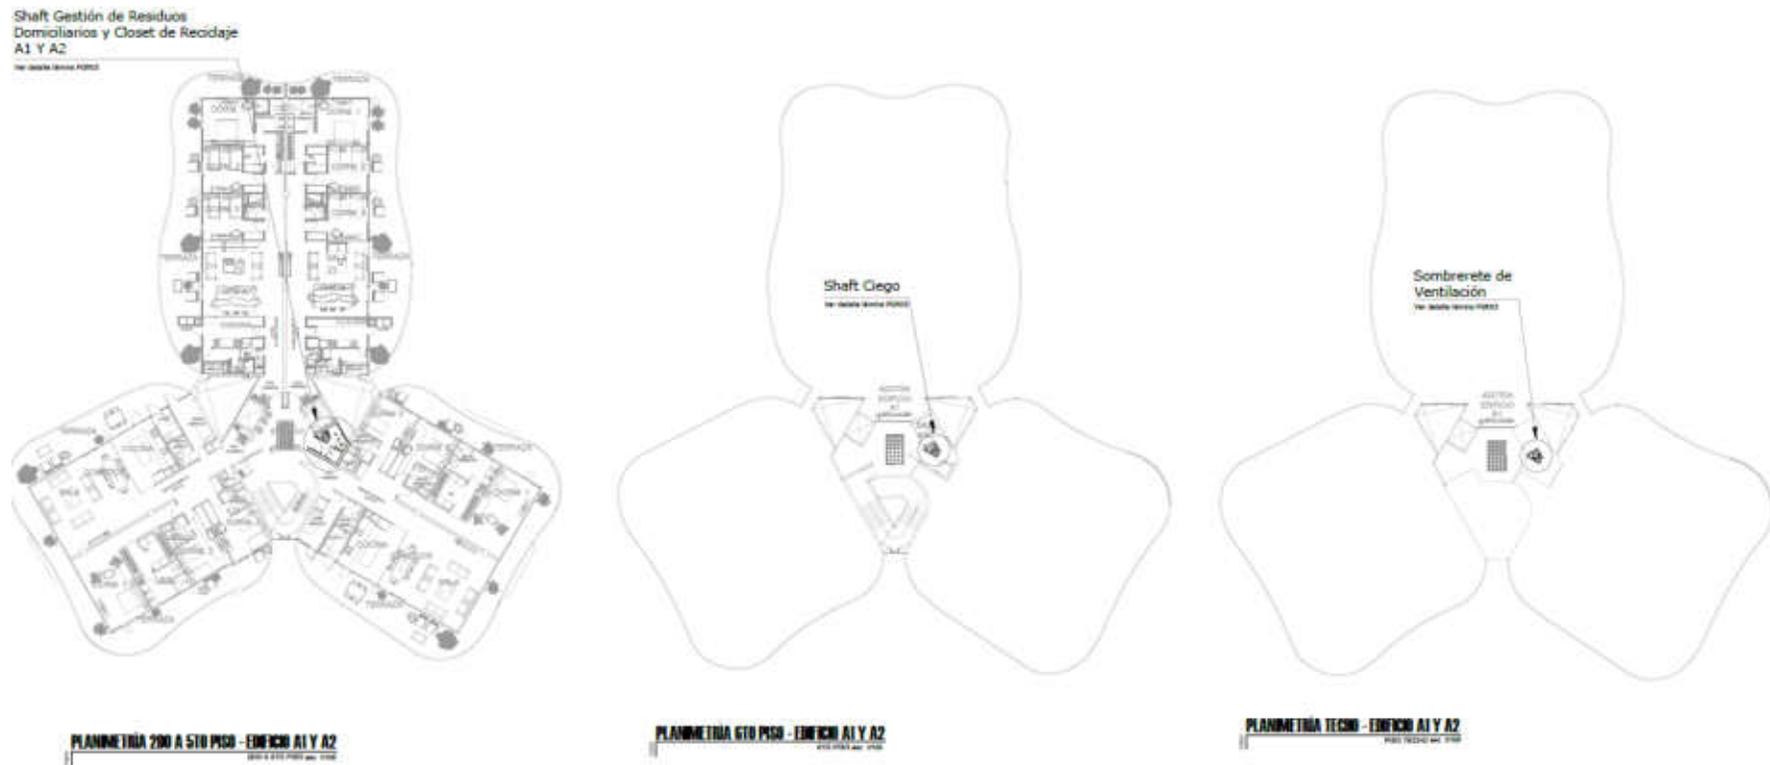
PSGR – Planimetría de 2do a Techo Piso – Edificio A1 y A2
